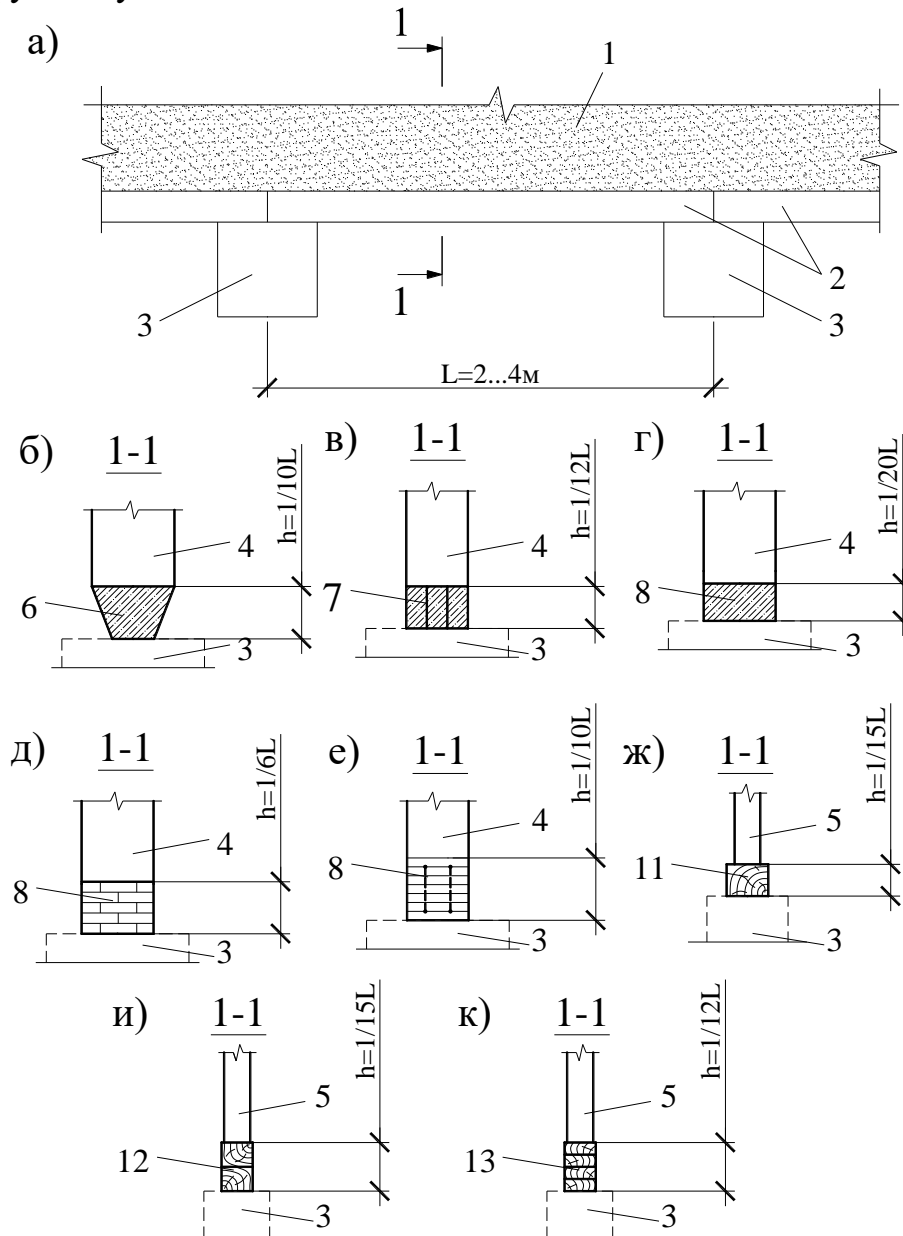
Конструктивні схеми стовпчастих фундаментів:
